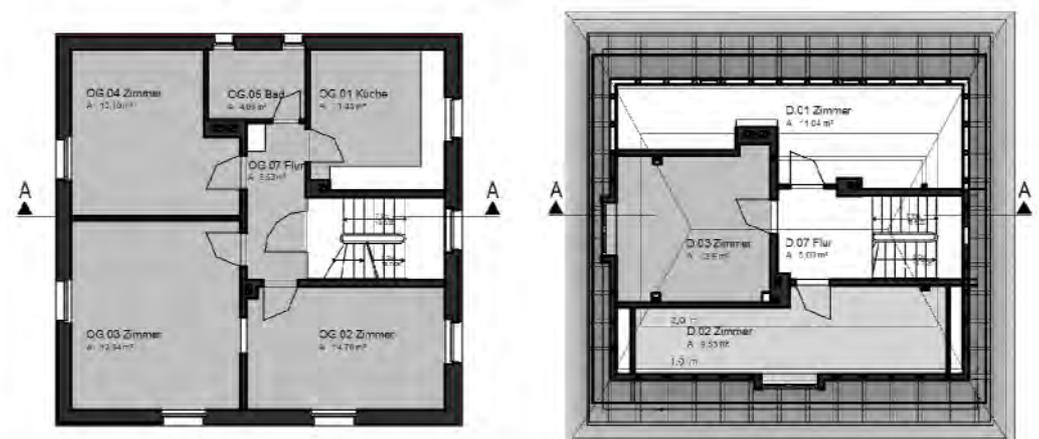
Grundriss Ober- und Dachgeschoss [Bestand]
